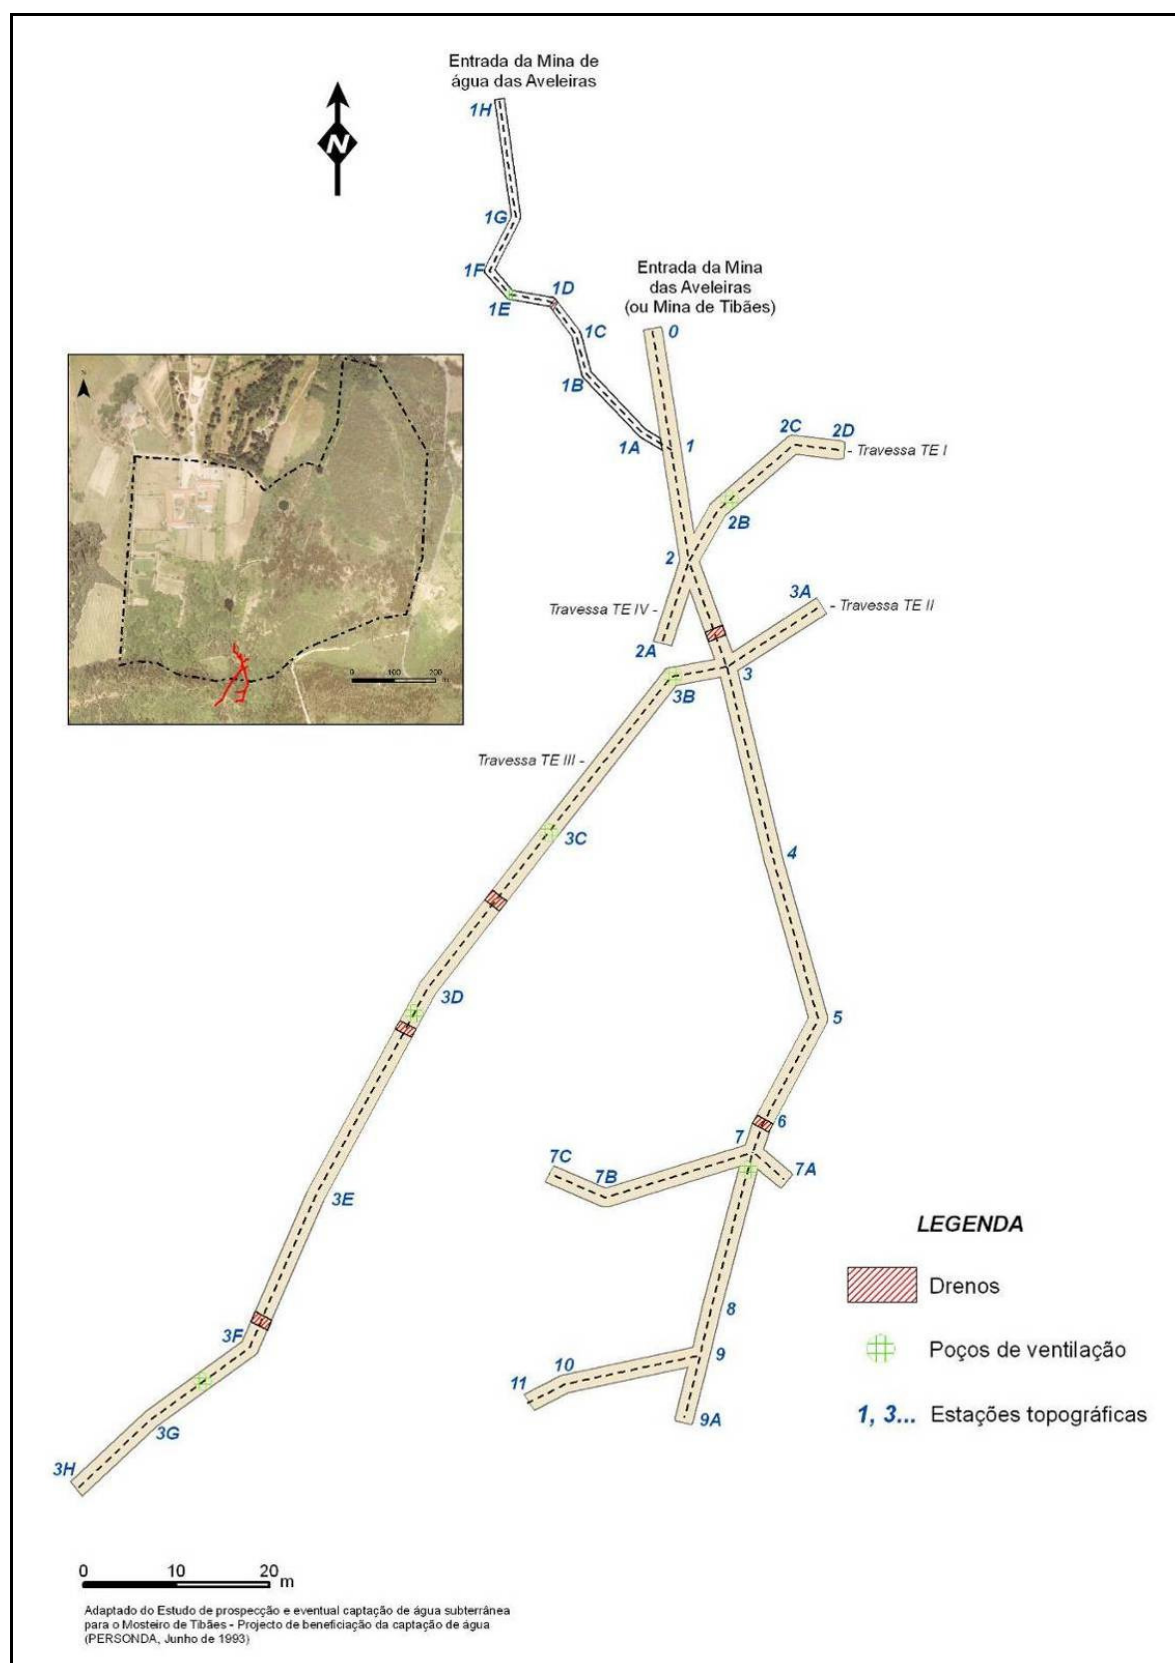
Traçado subterrâneo da Mina das Aveleiras (ou de Tibães) – adaptado de LABCARGA (2007/08) e Lopes et al. (2008).
